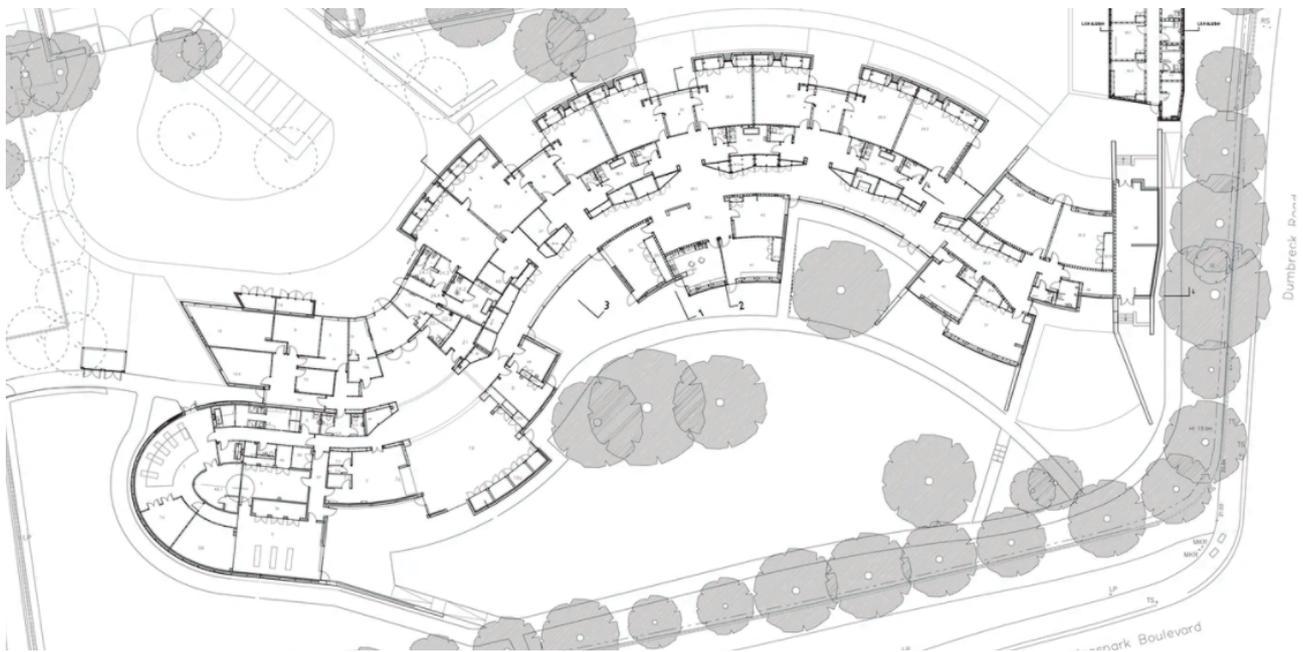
Planta, Hazelwood school. Fuente: Architizer.com
